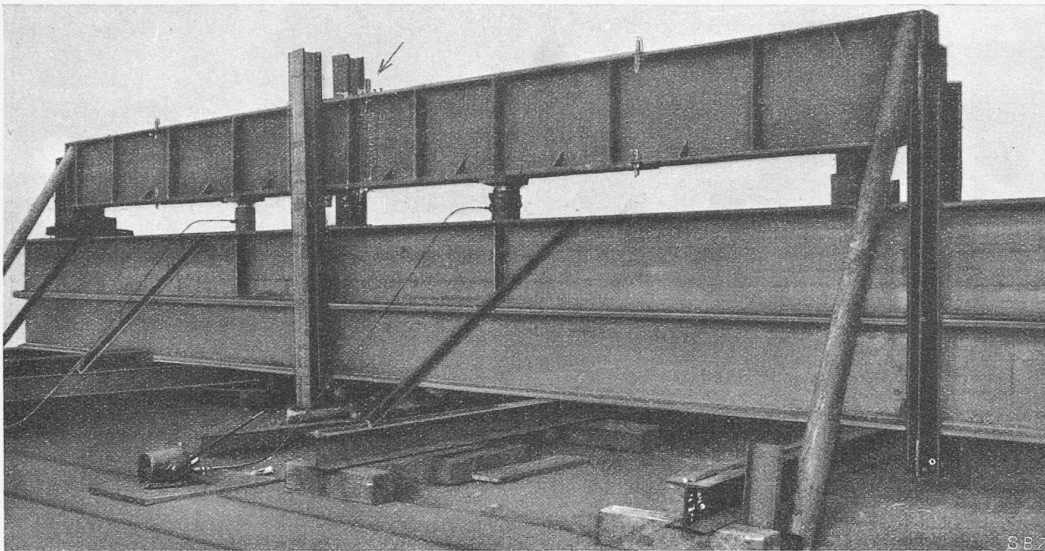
Der elektrisch geschweisste Blechträger auf dem Versuchstand.
